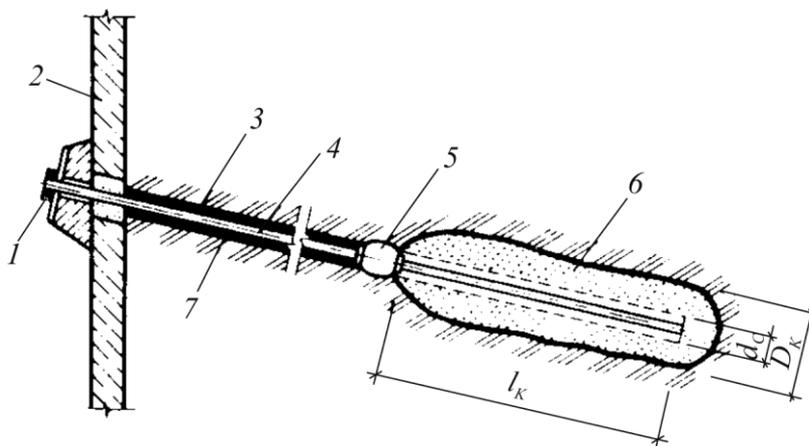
Инъекционный анкер: 1 – головка; 2 – анкеруемая конструкция; 3 – скважина; 4 – анкерная тяга; 5 – пакер; 6 – зона инъецированного грунта (корень); 7 – состав для защиты тяги от коррозии
